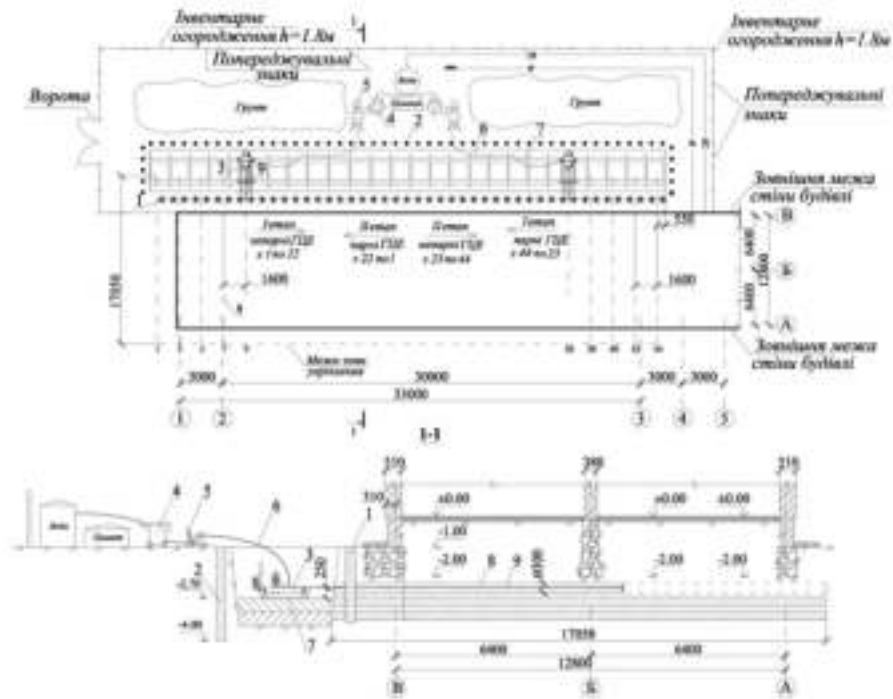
Технологічна схема підсилення основи фундаментів укріпленням ґрунтів горизонтальними ґрунтоцементними елементами: 1 – вертикальний ГЦЕ підпірної стінки; 2 – ГЦЕ укріплення укосів котловану; 3 – станок горизонтального буріння; 4 – розчиномішалка; 5 – розчинонасос; 6 - рукав; 7 – рейкові напрямні; 8 – горизонтальний ГЦЕ; 9 – бурові штанги
